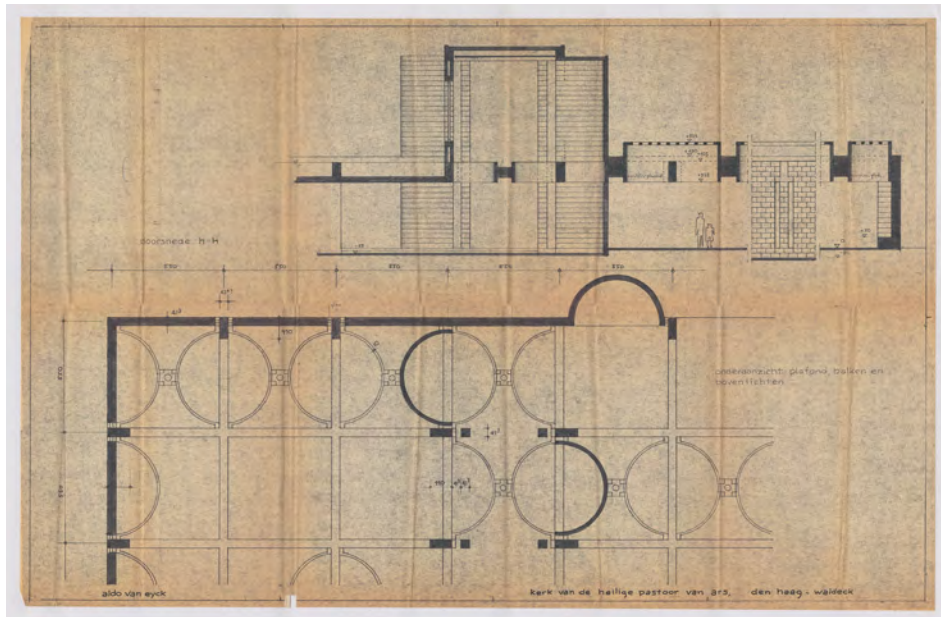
Plano 3.3. Alzados y secciones (detalle de las secciones longitudinales aa, bb y cc).
